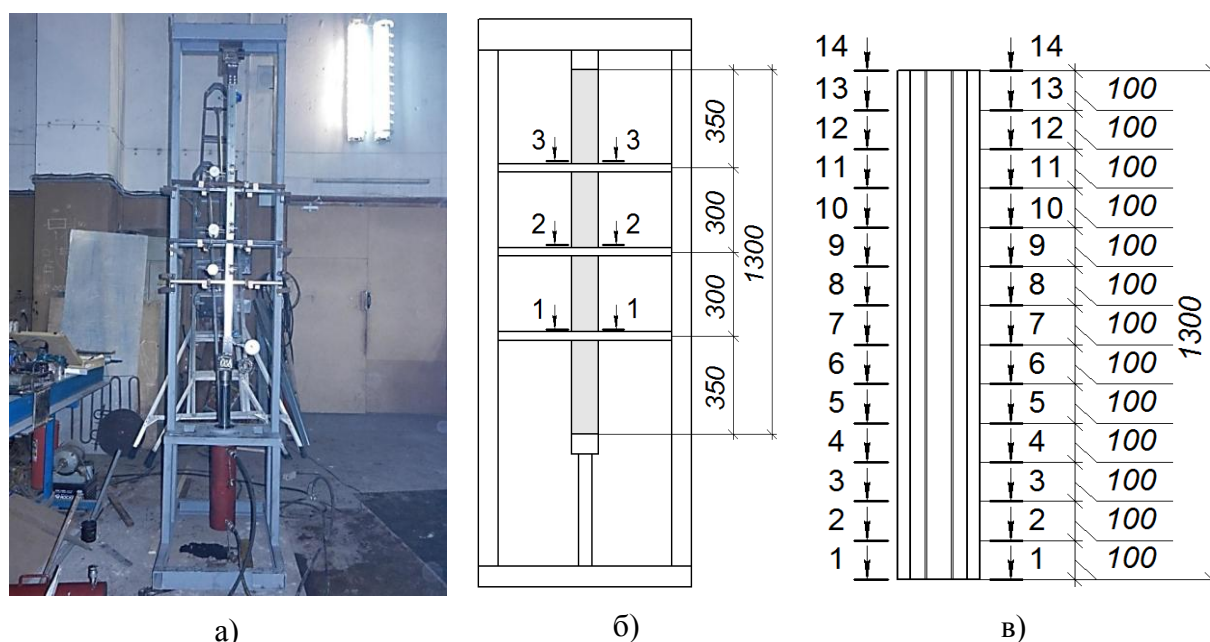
а) испытательный стенд, готовый к работе; б) схема установки индикаторов на испытуемый образец; в) схема сечений по длине профиля
